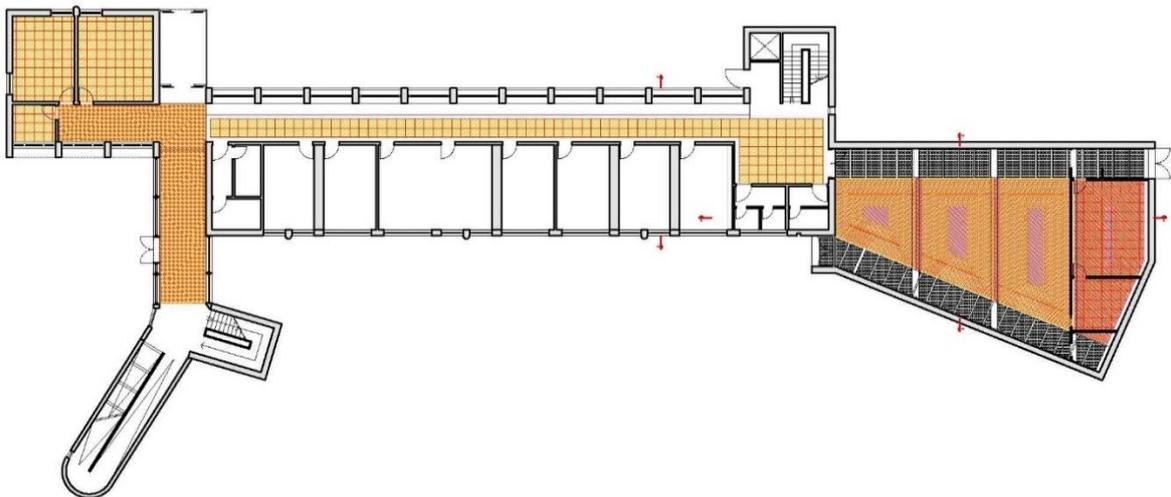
COMPARATIVA – Pianta dei controsoffitti piano terra
